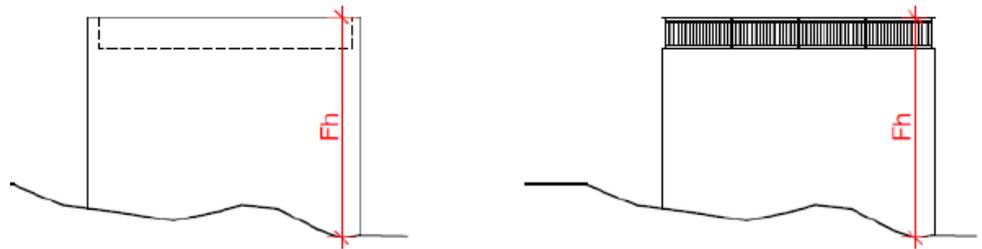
Schema Messweise Fassadenhöhe bei Flachdachbauten
